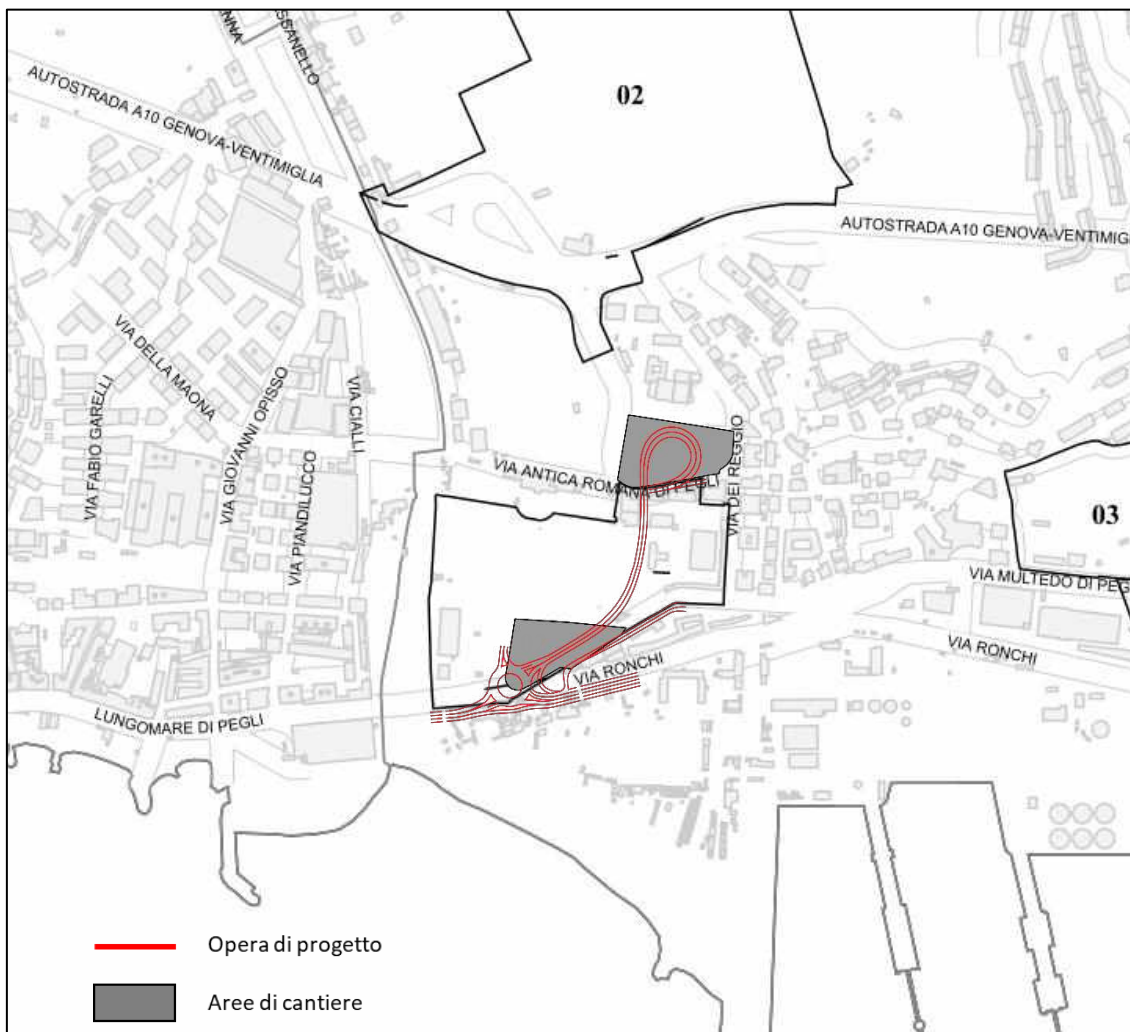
Distretto di trasformazione 2 Carmagnani – Fondegga Sud
